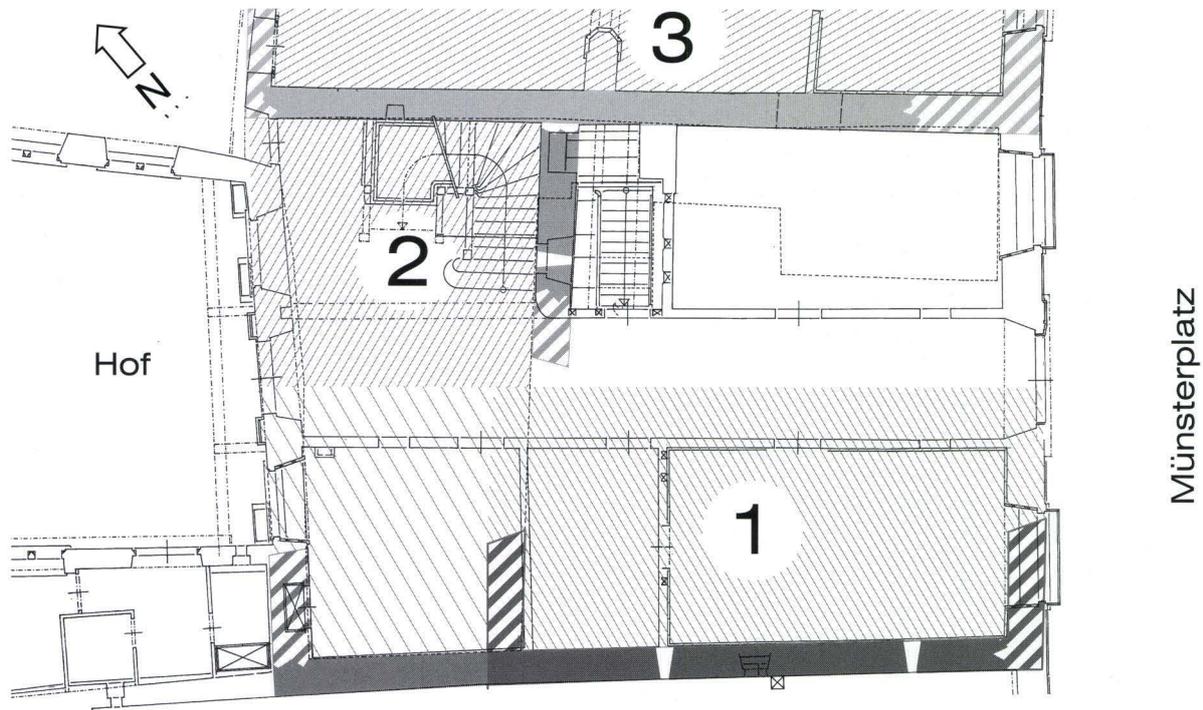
Grundriss Vorderhaus mit eingetragenen Phasen von früheren Bebauungen. – Plangrundlage: Kunstdenkmälerinventarisat ion BS. Zeichnung: H. Ritzmann.
